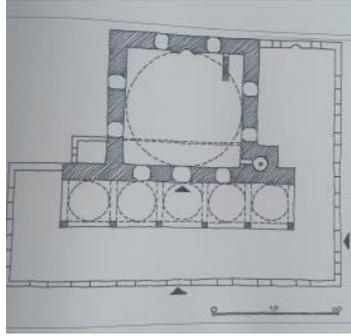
مسقط أفقي لمسجد صوفي محمد باشا في صوفيا ببلغاريا
